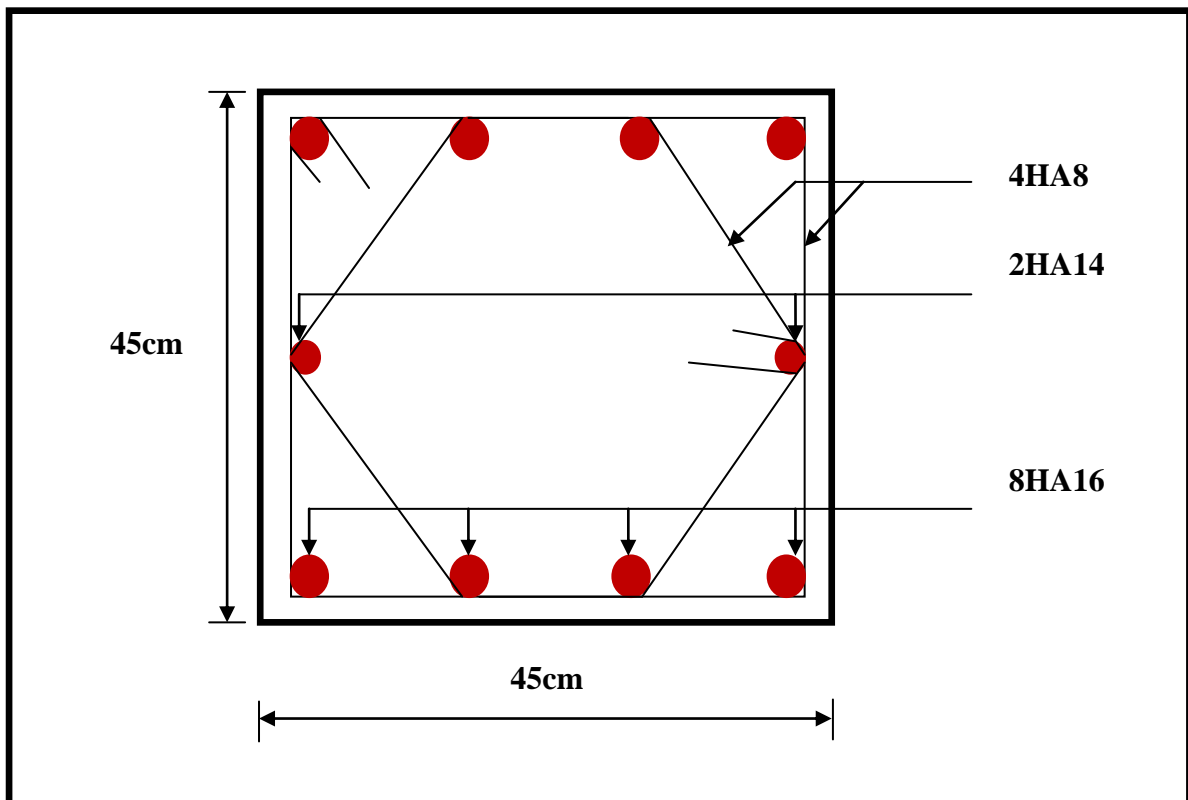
Ferrailage Poteau 45 × 45
